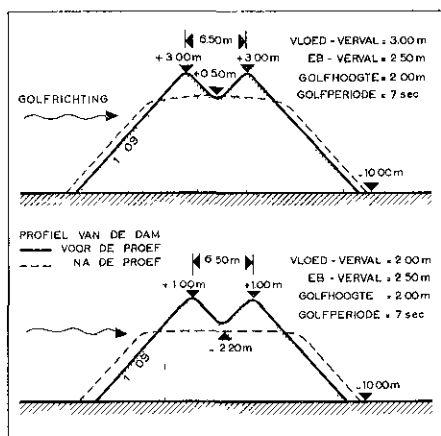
Vervorming van een uit betonblokken opgebouwde dam met dubbele kruin onder invloed van stroom uit twee richtingen en golven uit één richting
